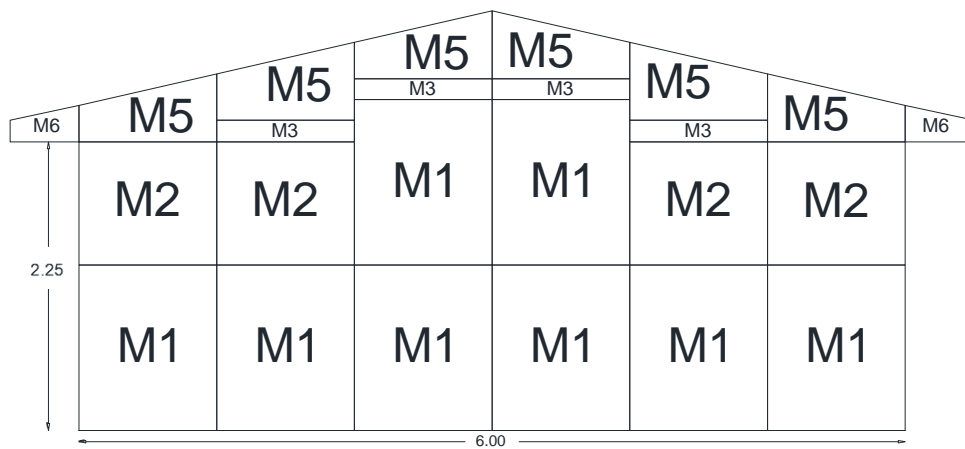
Armado de módulos para el muro 6 de la vivienda tipo social.
